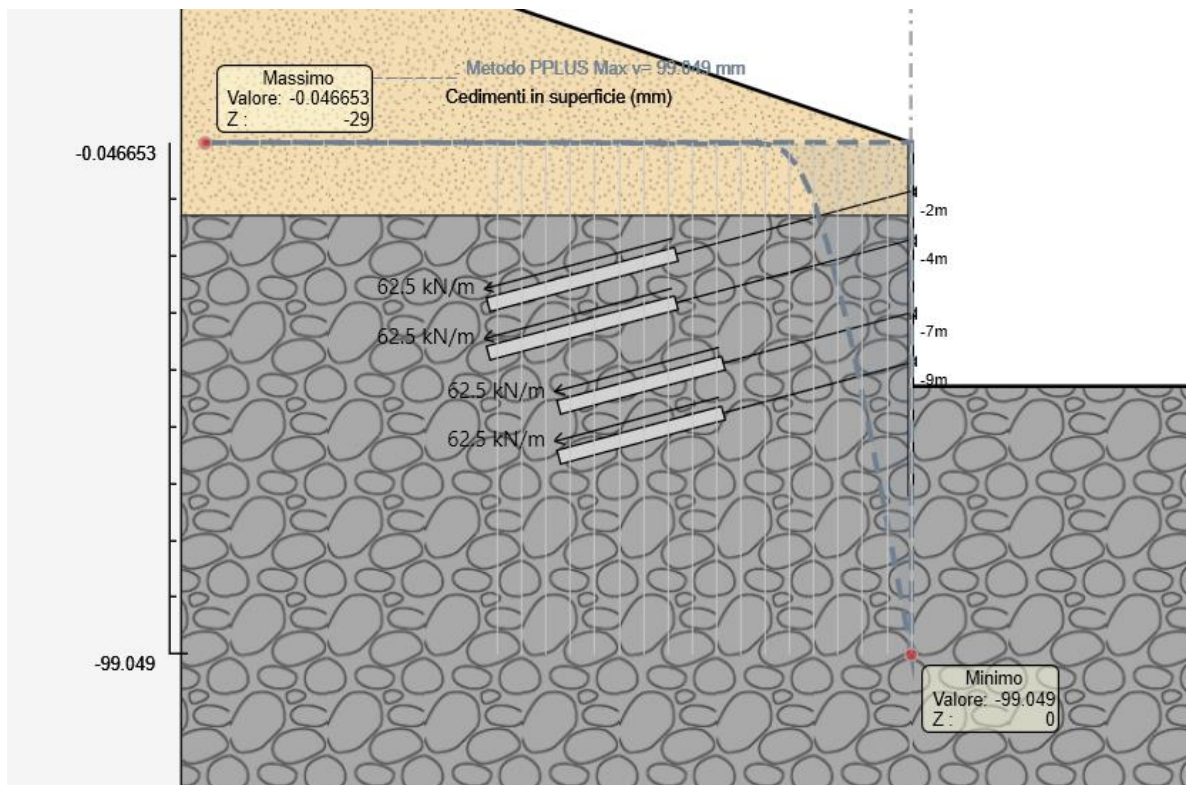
Sezione 3 – Cedimenti verticali [mm] – Inviluppo SLE
